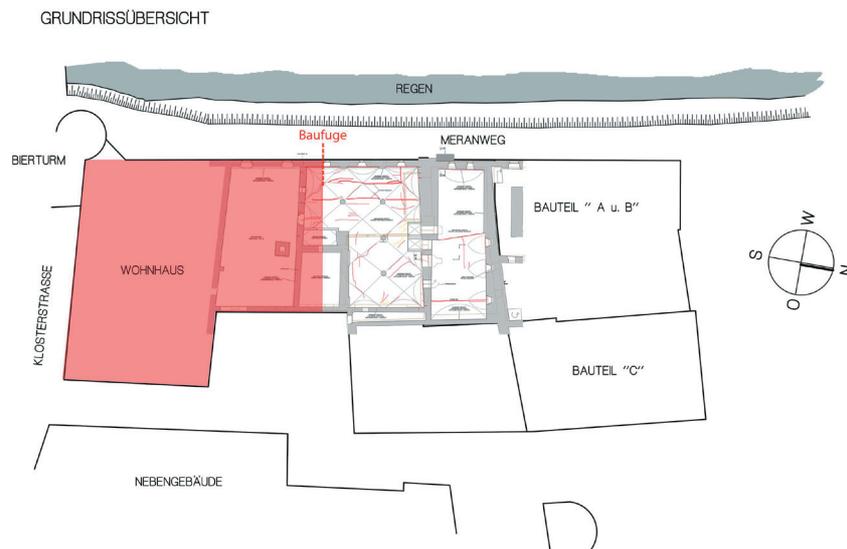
Lageplan des Höchstetterareals mit dem vermuteten Grundriss des ersten Baus des „Chamer Stadtschlusses“ aus dem Plangutachten der Firma ALS von 2009
